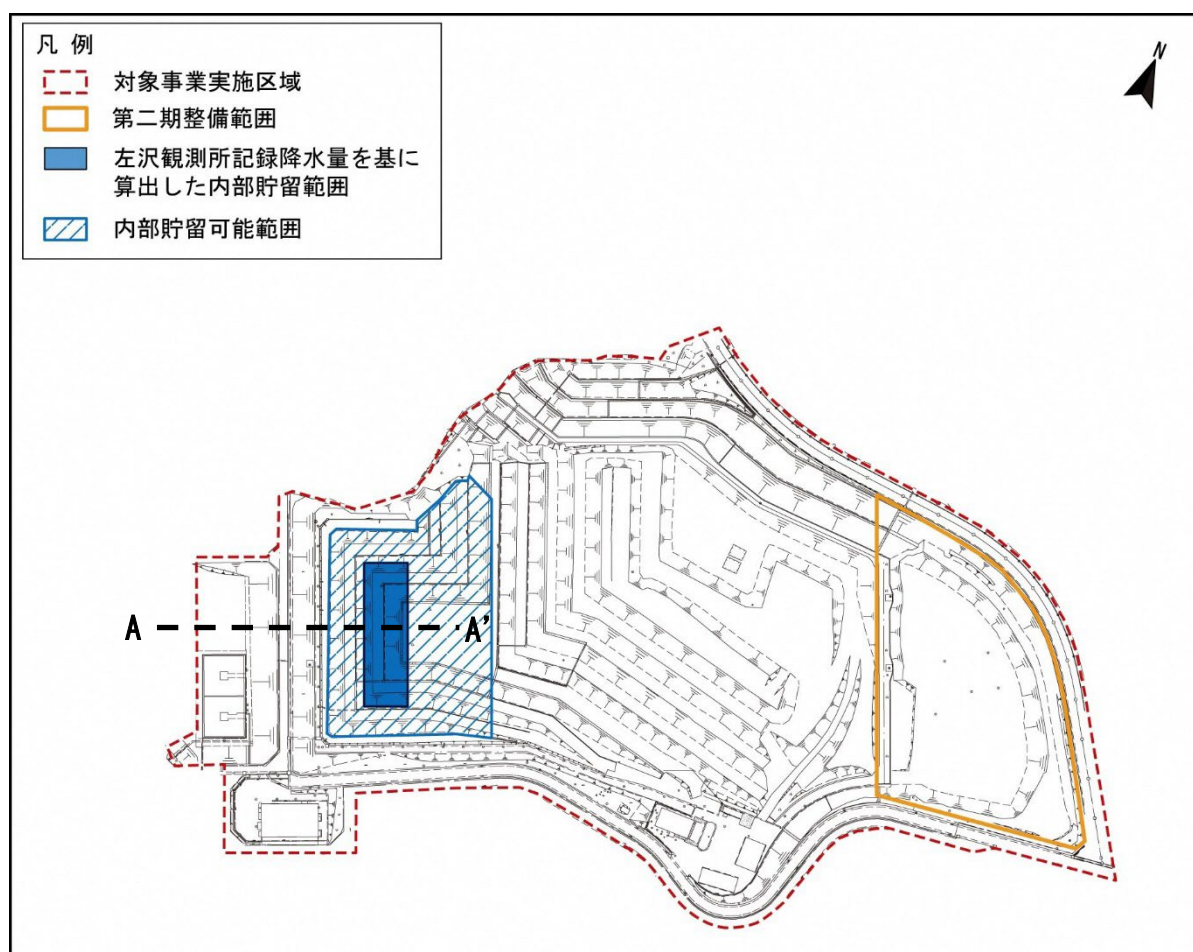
第一期埋立部における埋立地内部貯留範囲（平面図）
